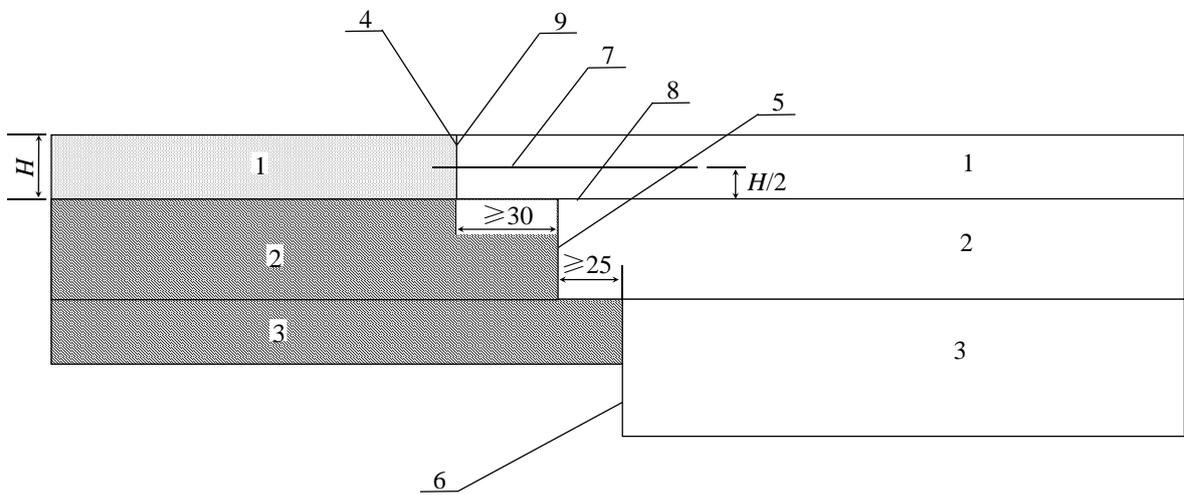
水泥混凝土路面结构拼接水泥混凝土路面结构典型拼接构造图（尺寸单位：cm）
